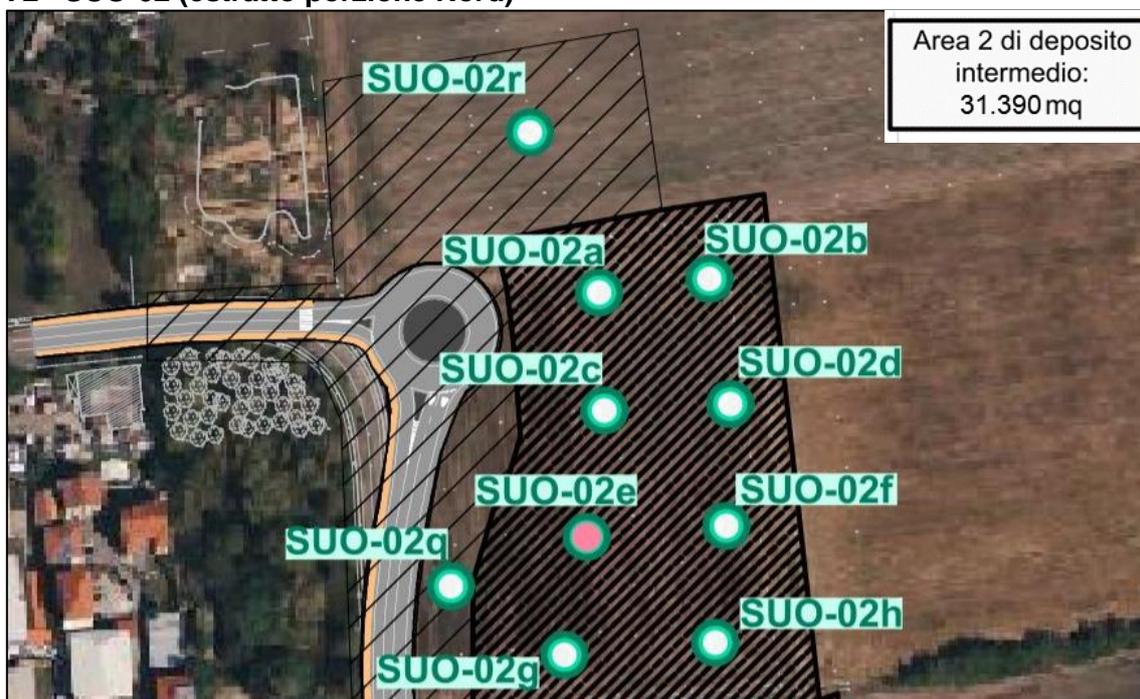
Planimetria punti di prelievo Area 2 (porzione Nord).
